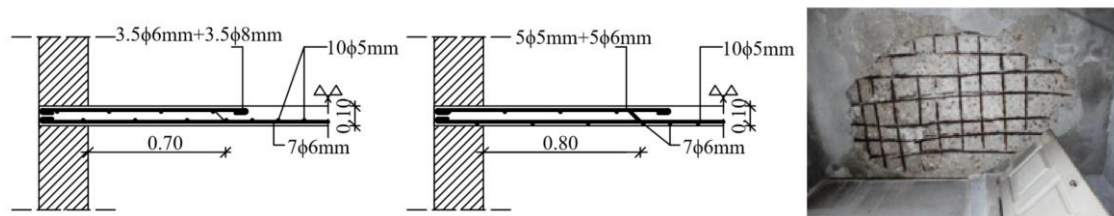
16 - Laje de betão armado: direção x, direção y e laje encontrada in situ com graves problemas de corrosão das armaduras, respetivamente (Lopes et al., 2008).
